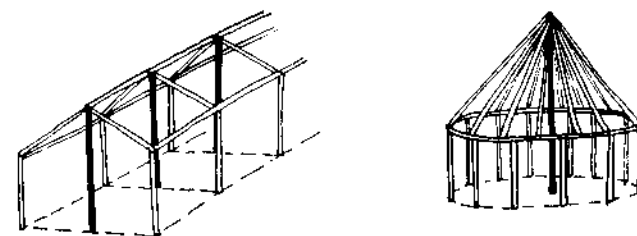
Estructuras en arco-planta rectangular y circular.
